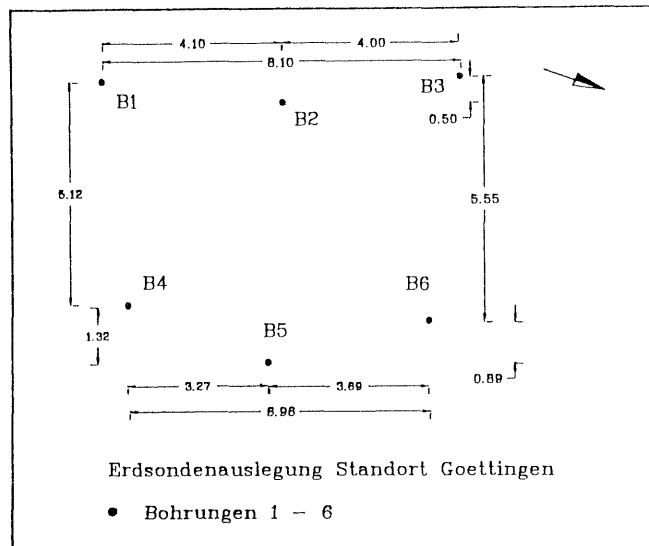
Lageplan der Erdsondenanlage Göttingen
